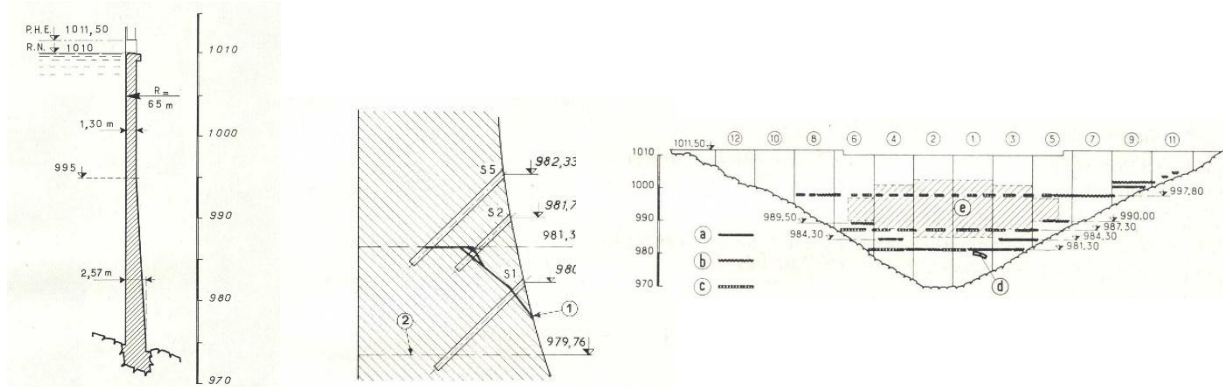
Barrage du Gage 1. Coupe en partie centrale. Fissure plongeante en parement aval. Fissuration en parement aval.
